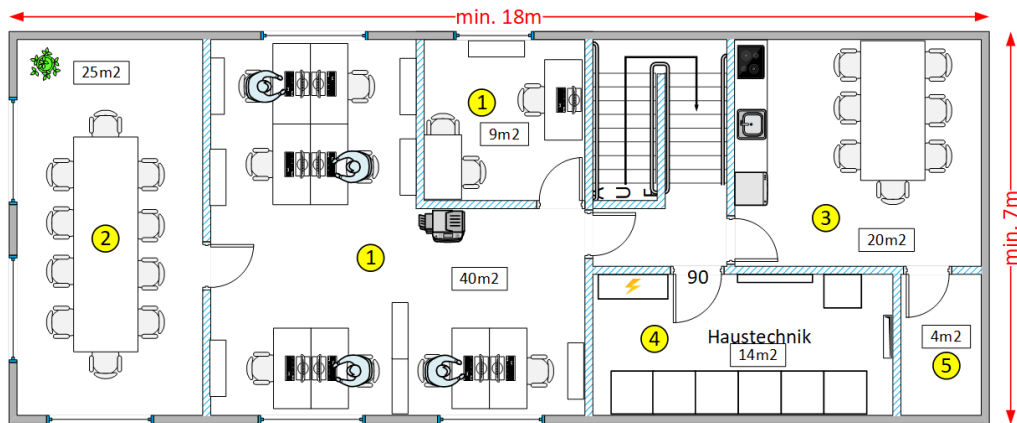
Grundriss Muster Bürogebäude OG
